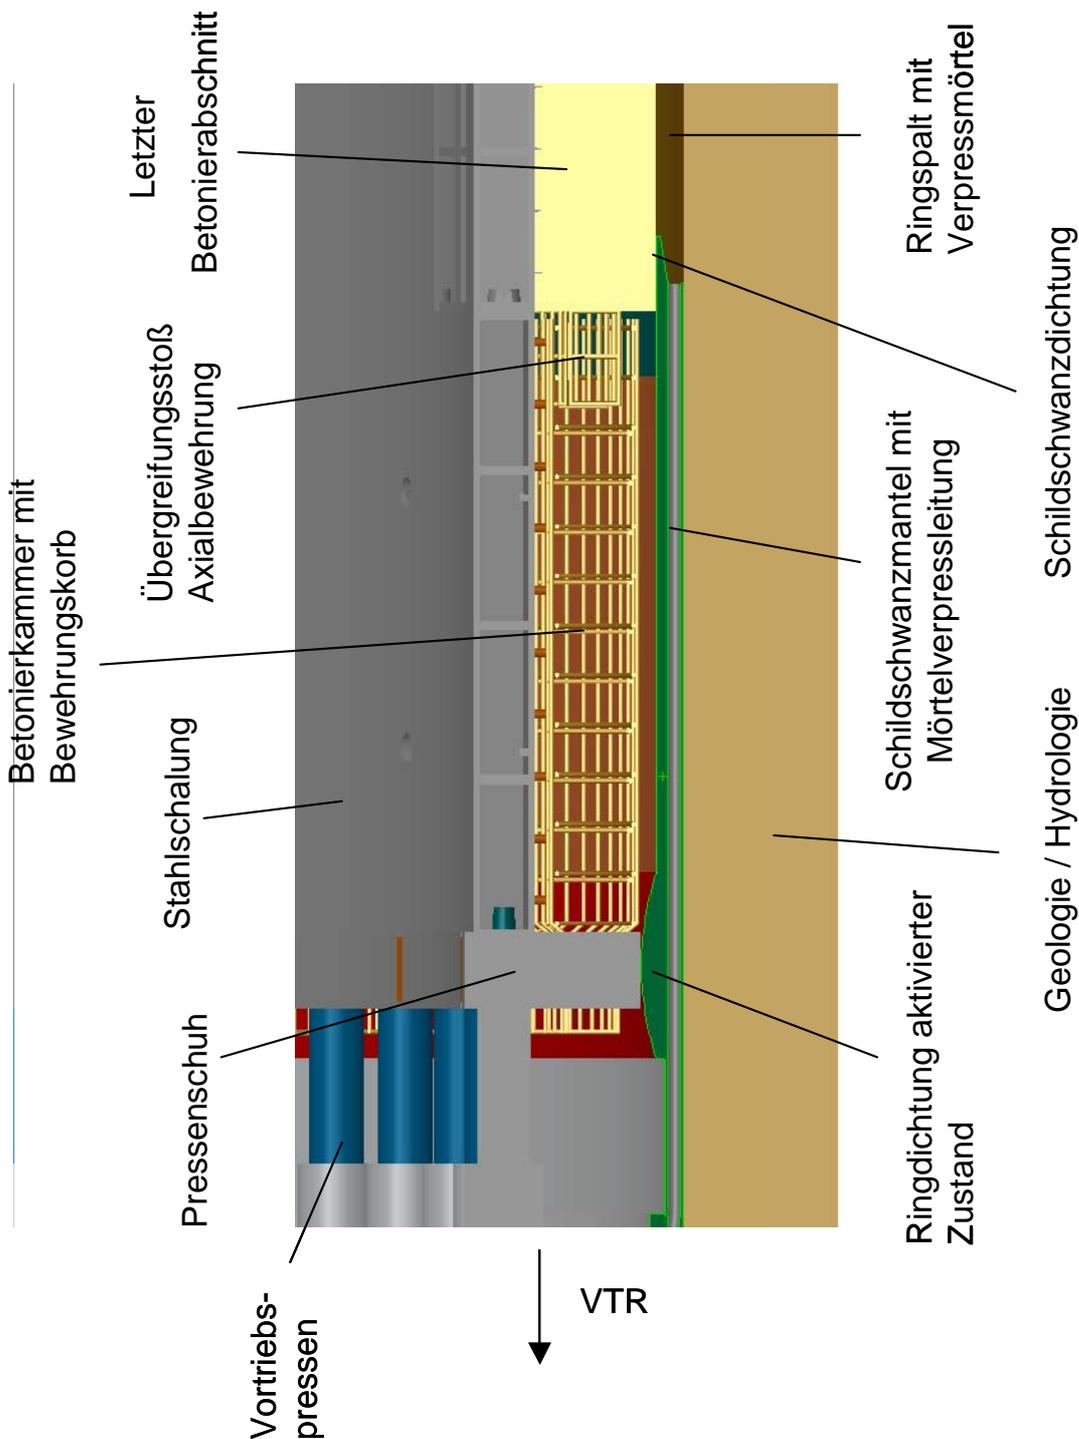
Detail: horizontaler Schnitt durch die Betonierkammer
